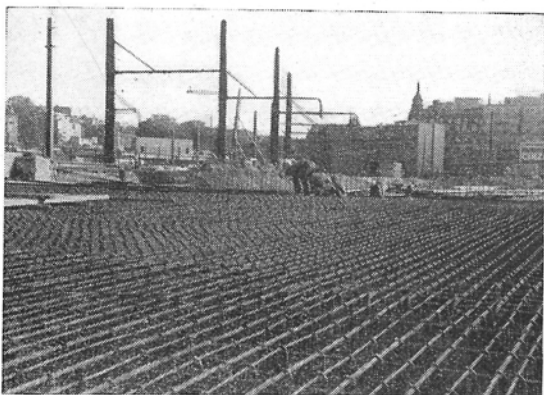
Vloerdek van gewapend beton (betonijzer).
